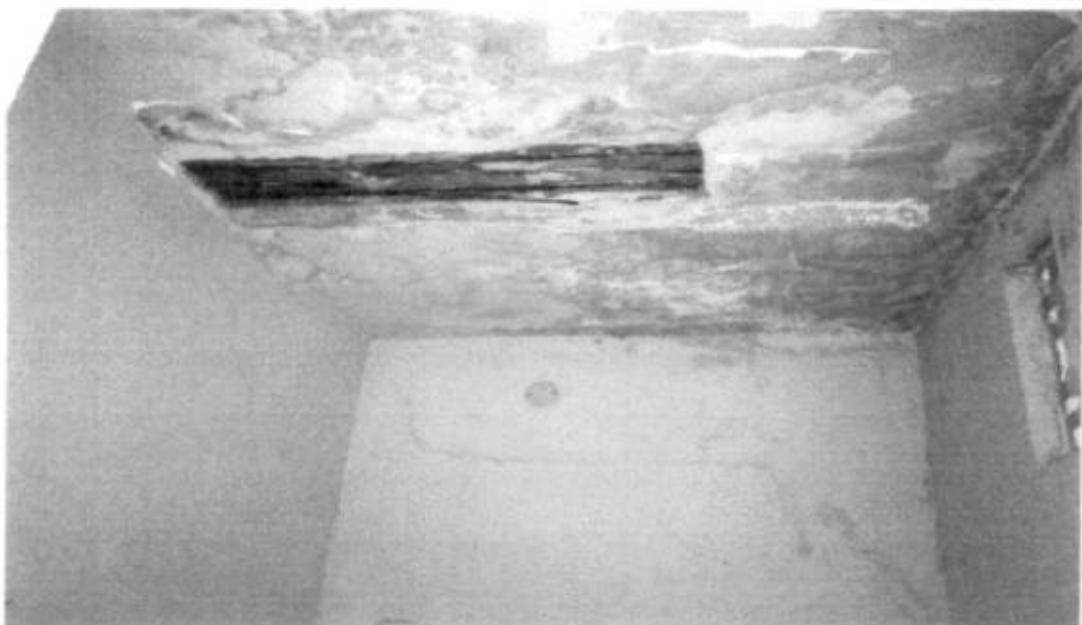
Laje da caixa d'água com elevada oxidação da armadura e descolamento do revestimento
